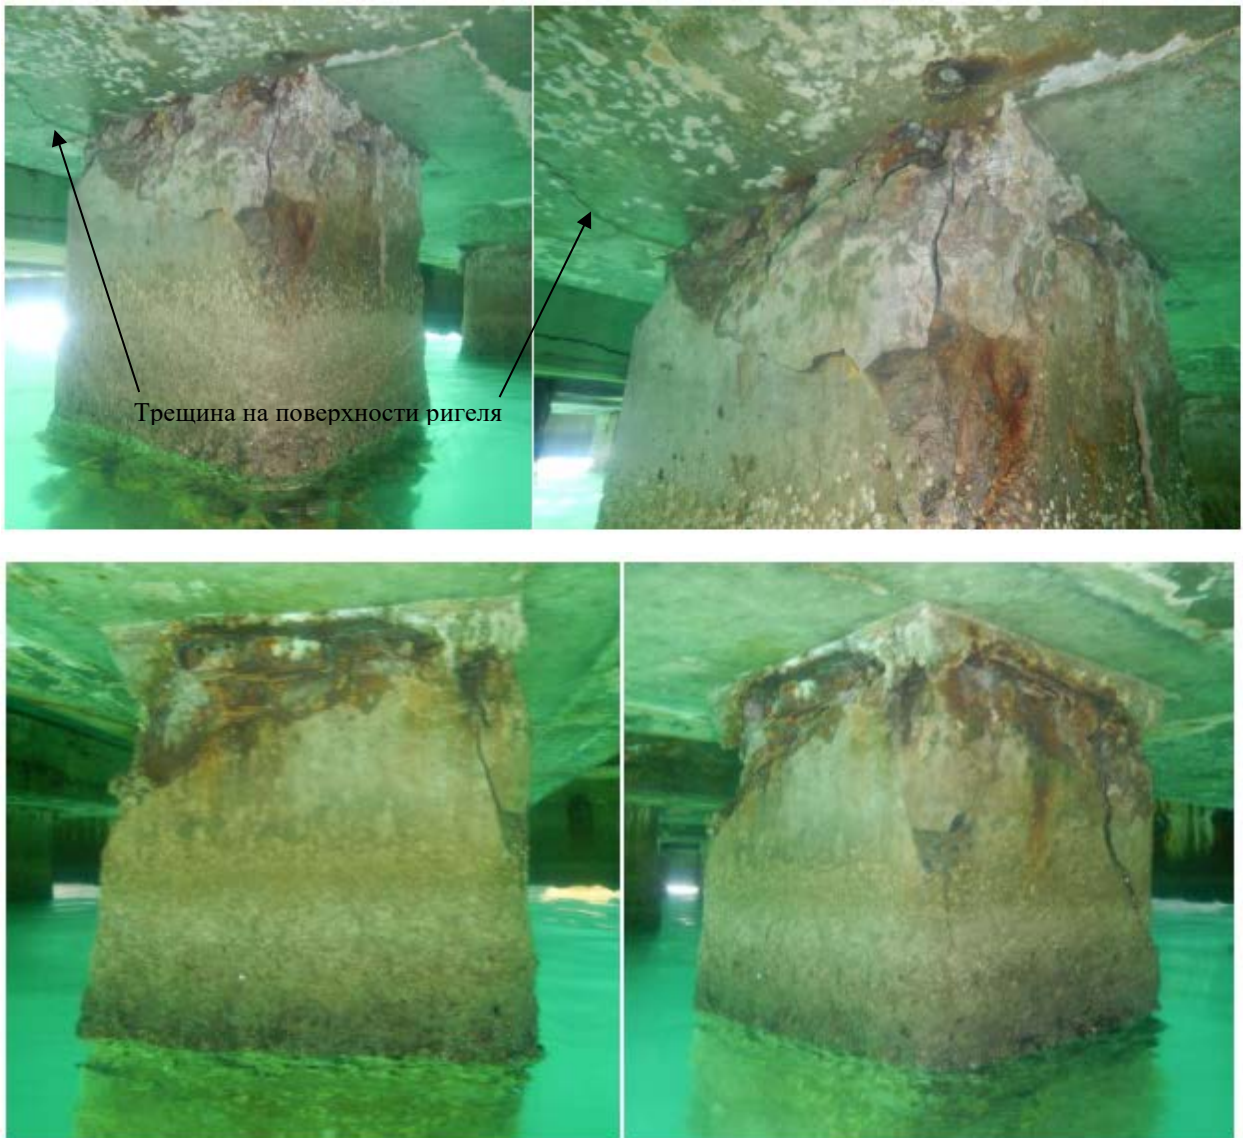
Разрушение бетона с оголением и коррозией арматуры в узле заделки свай и трещины на поверхности свай
